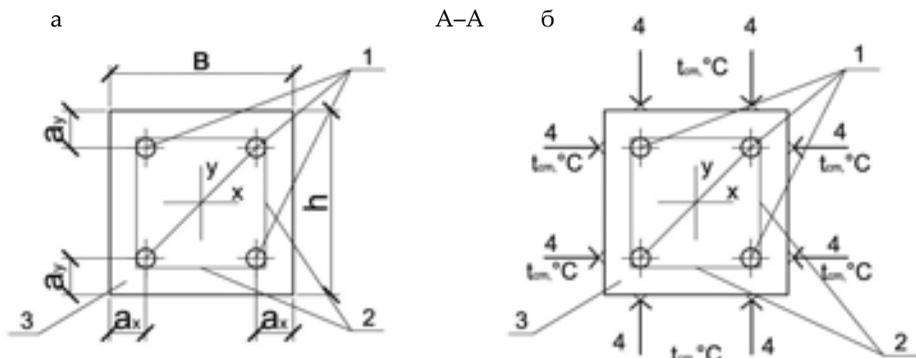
Расчетная схема сжатого железобетонного пояса (сечения А-А) при оценке:
